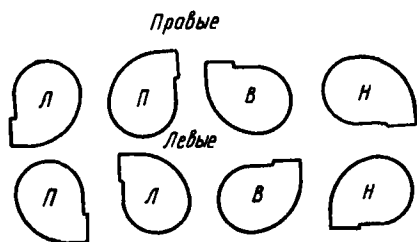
Различные положения кожуха центробежного вентилятора:
